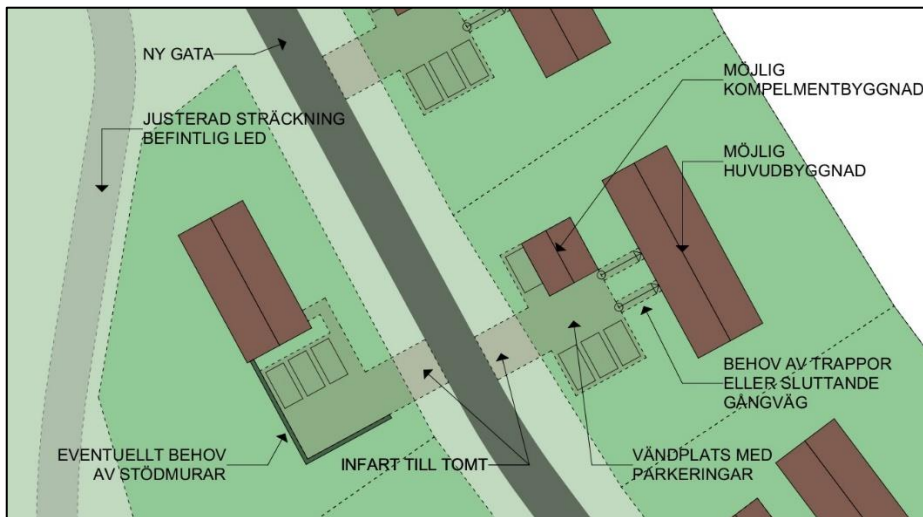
Illustration av möjliga sätt att bebygga fastigheter inom planområdet.
